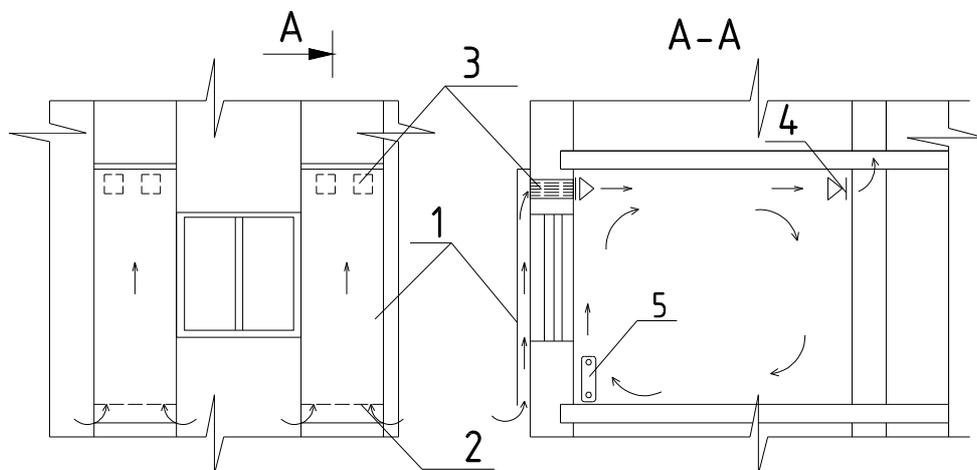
Устройство фасада здания с рекуперативными приточными вентиляционными блоками: 1- навесной фасад; 2 – щелевые зазоры; 3 - вентиляционное приточное устройство типа РПВЭ; 4 – вытяжная решетка; 5- отопительный прибор
